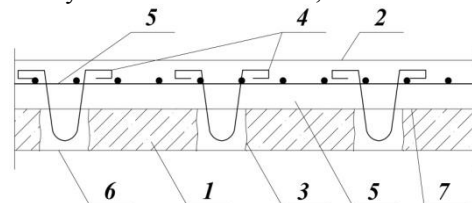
Наращивание монолитного слоя сверху с устройством железобетонных шпонок [16]:
